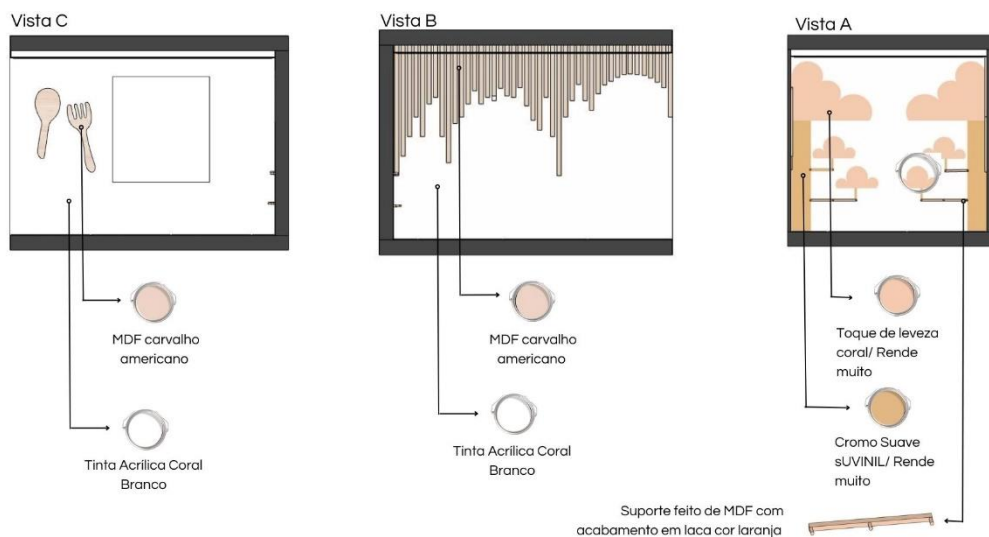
Refeitório: Planta Baixa dos Acabamentos
